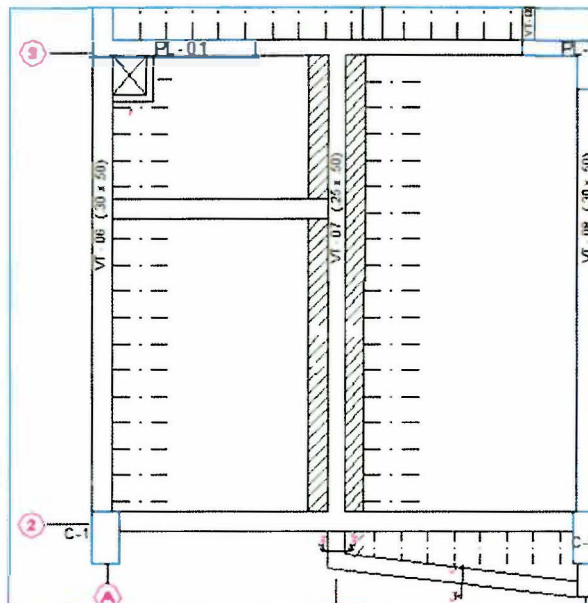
a: viga VT-07 (25x50) apoyadas sobre vigas
